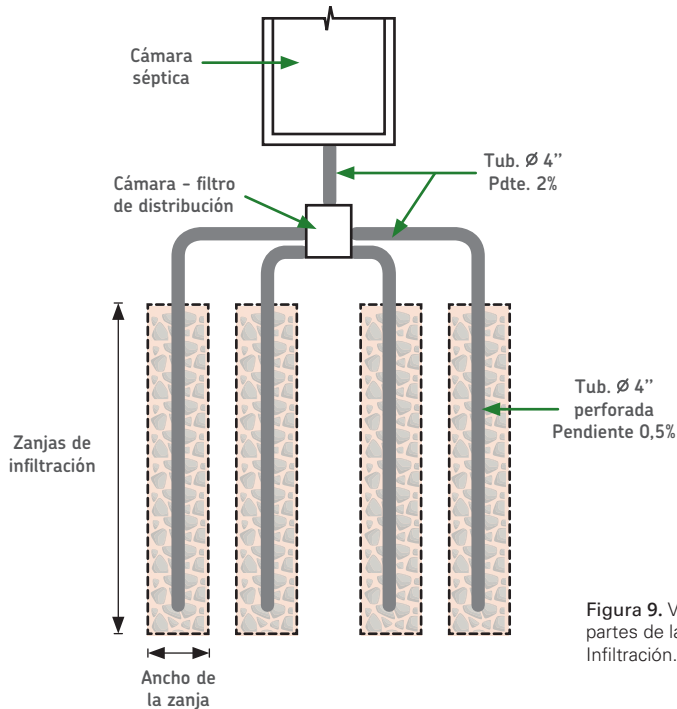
Vista en planta, partes de las Zanjas de Infiltración.
